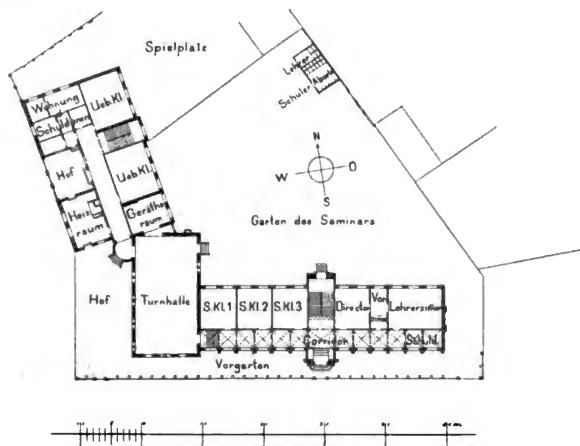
Grundriß des Lehrerseminars an der Hamburgerstraße.
